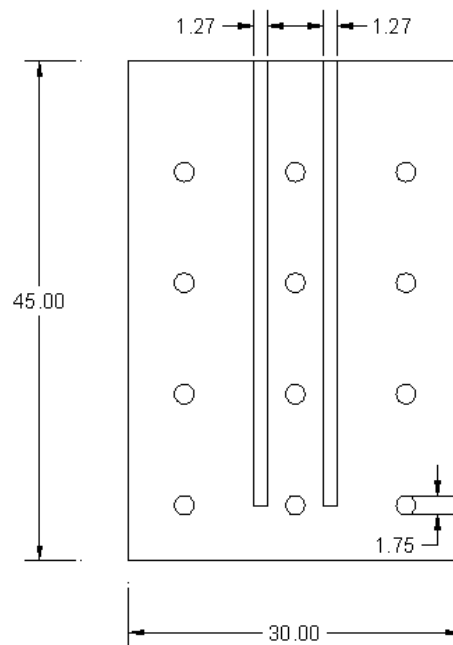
Plancha metálica sobre la cual irán los pernos de anclaje (Vista en planta)
